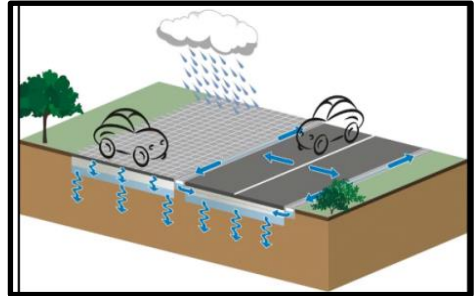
structure réservoirs infiltrantes:à gauche, parking poreux à droite, chaussée réservoir à injections d'eau latérales
